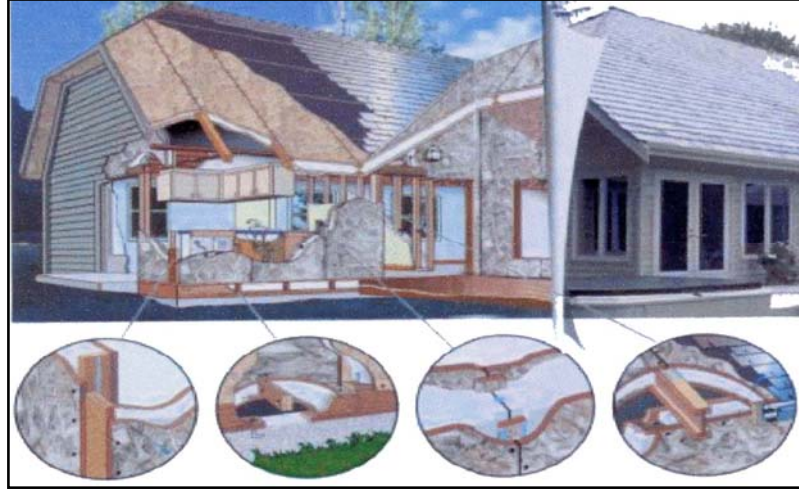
Platform sistemlerde kullanılan duvar detayı (Jelovica-Prefabricated Houses Industry)
